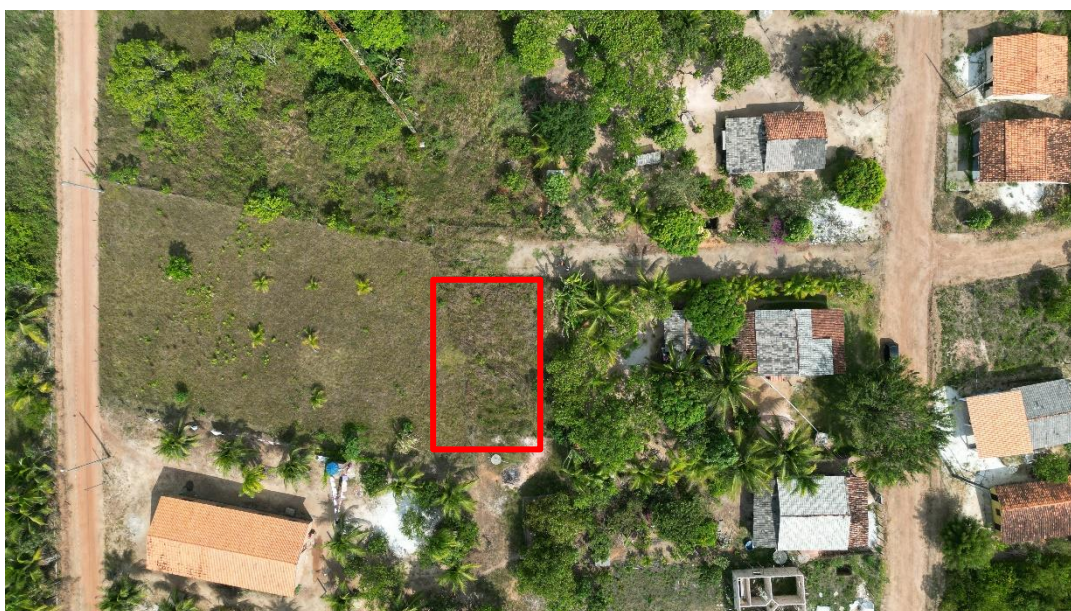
Terreno a ser implantado o Sistema de abastecimento de Água da Vila da Estiva.
